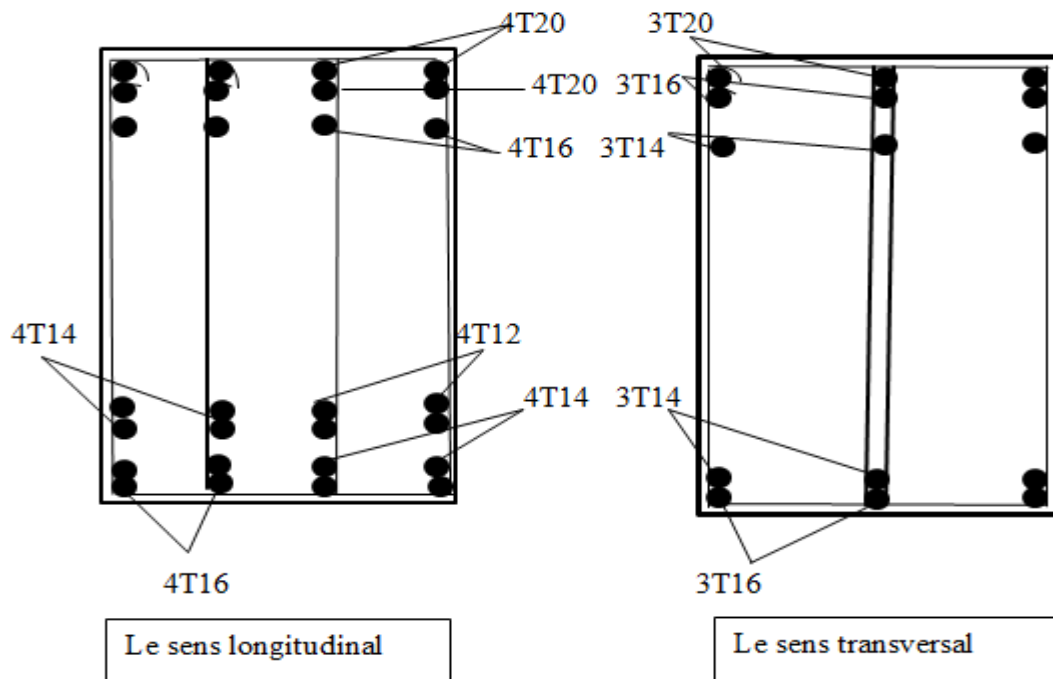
Ferrailage de la poutre suivant les deux sens.
